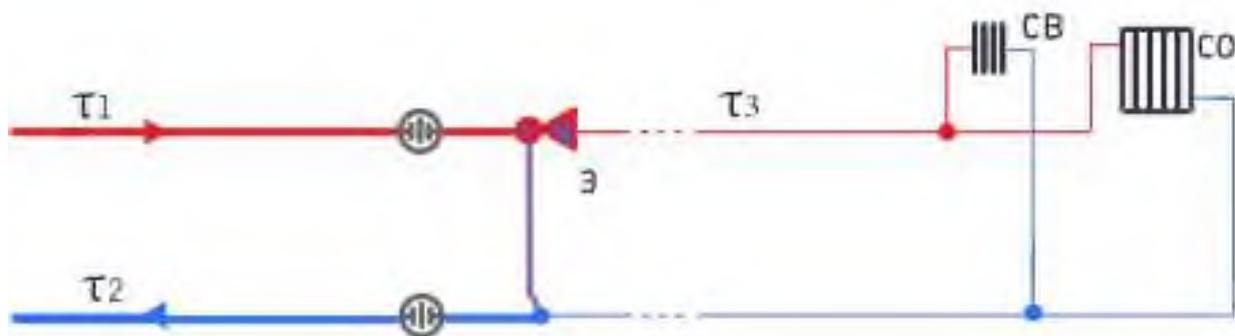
ЦТП с элеваторным присоединением СО и СВ
